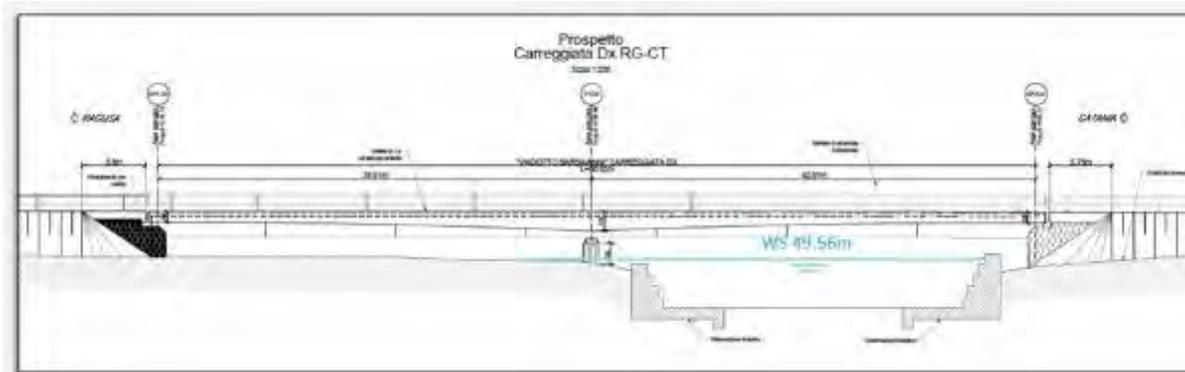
Sezione longitudinale del Viadotto sul Fiume Barbaiani in progetto
